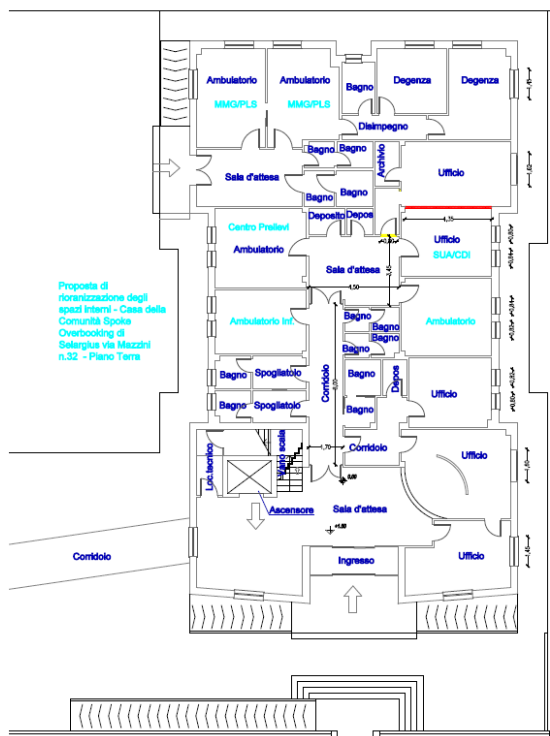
Planimetria della CdC Spoke overbooking di Selargius, con proposta di riorganizzazione degli spazi interni.
